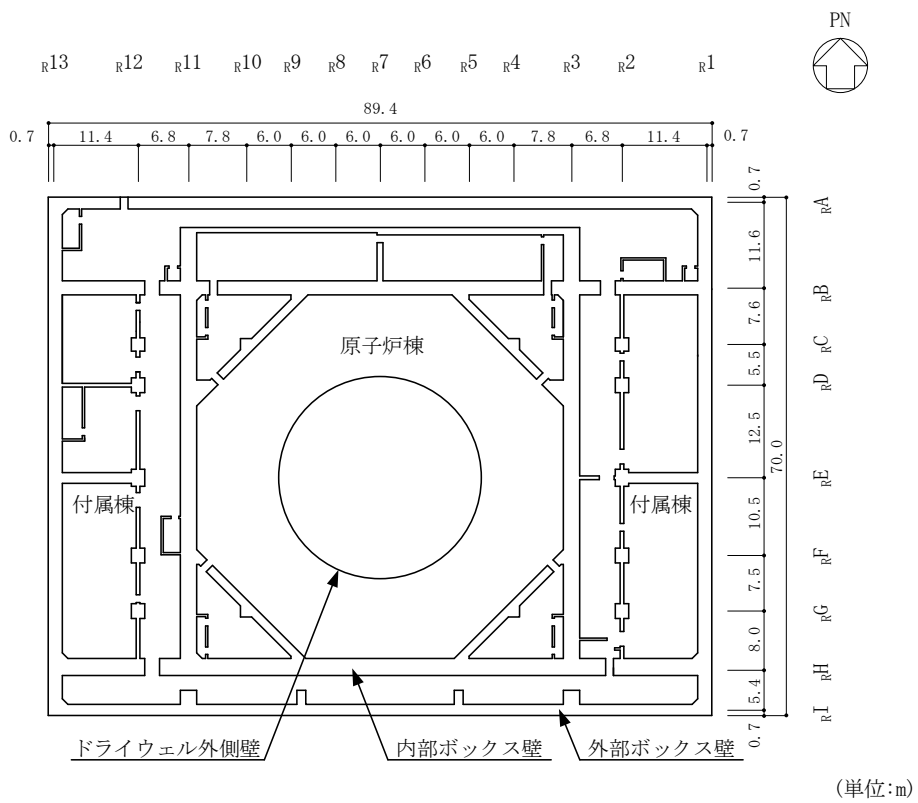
原子炉建物基礎スラブの概略平面図 (EL 1.3m*)
